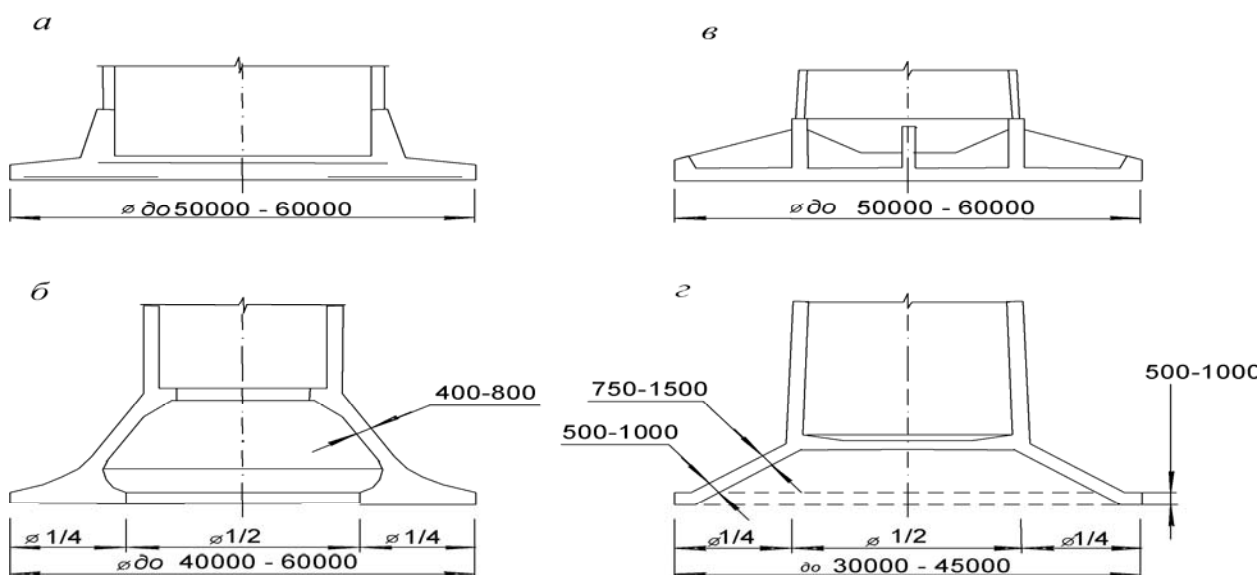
Фундаменты под сооружения башенного типа:
